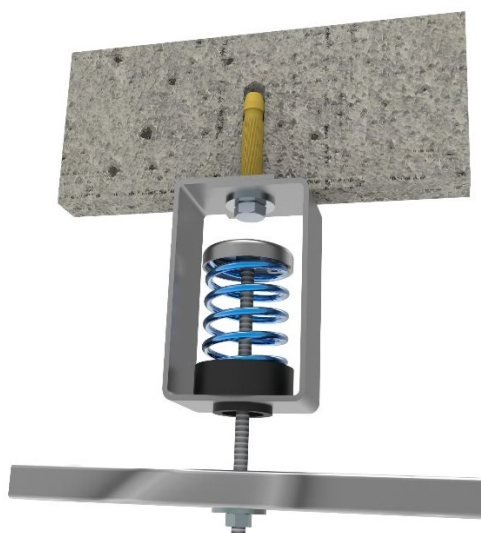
Fuente de vibración fijada al muelle. Estructura metálica instalada en la estructura.
